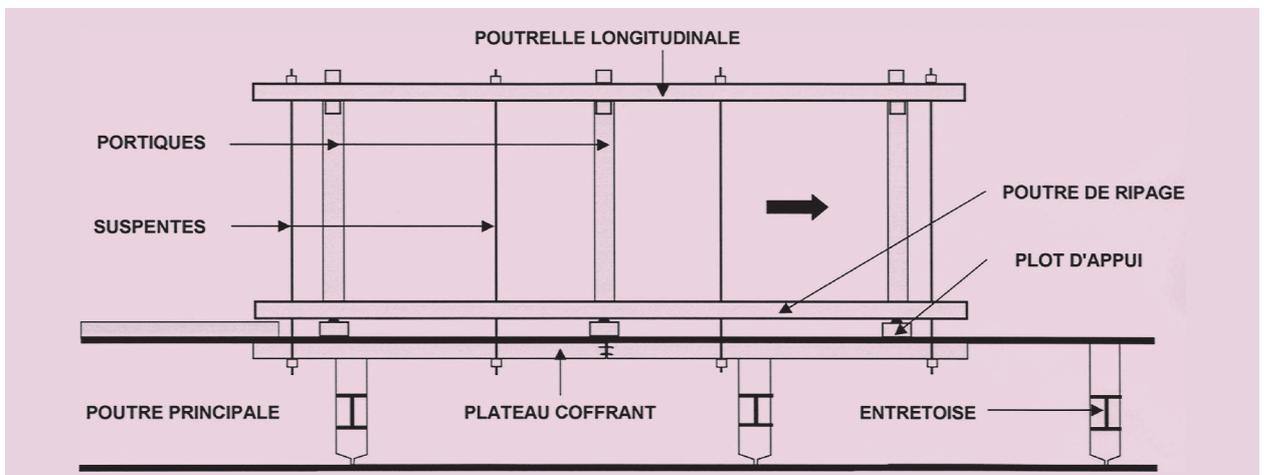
Vue longitudinale d'un équipement mobile pour bipoutre à entretoises (le ferrailage du plot en construction n'est pas représenté)
